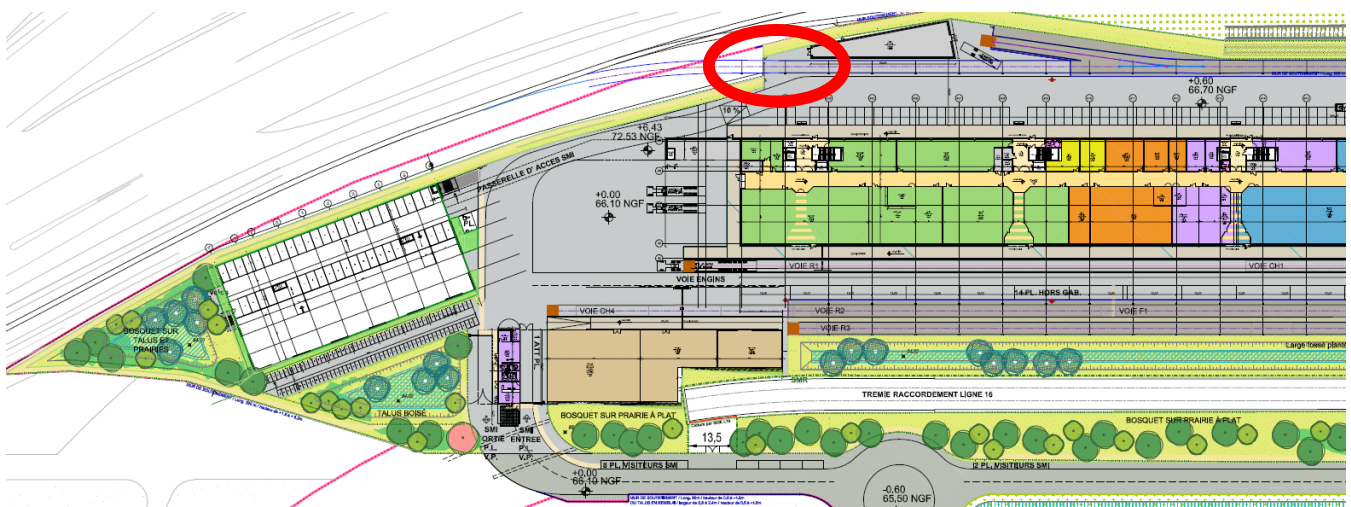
Extrait du plan masse du projet – Repérage du raccordement du SMI au RFN
